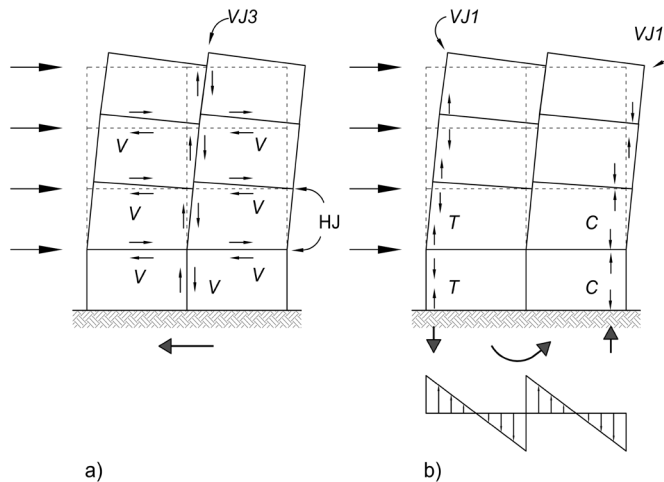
Muri prerës i parafabrikuar beton arme beton arme që i nënshtrohet ngarkimit sizmik në plan: a) forcat prerëse dhe b) forcat tërheqëse dhe shtypëse (bazuar në FIB 2008).
